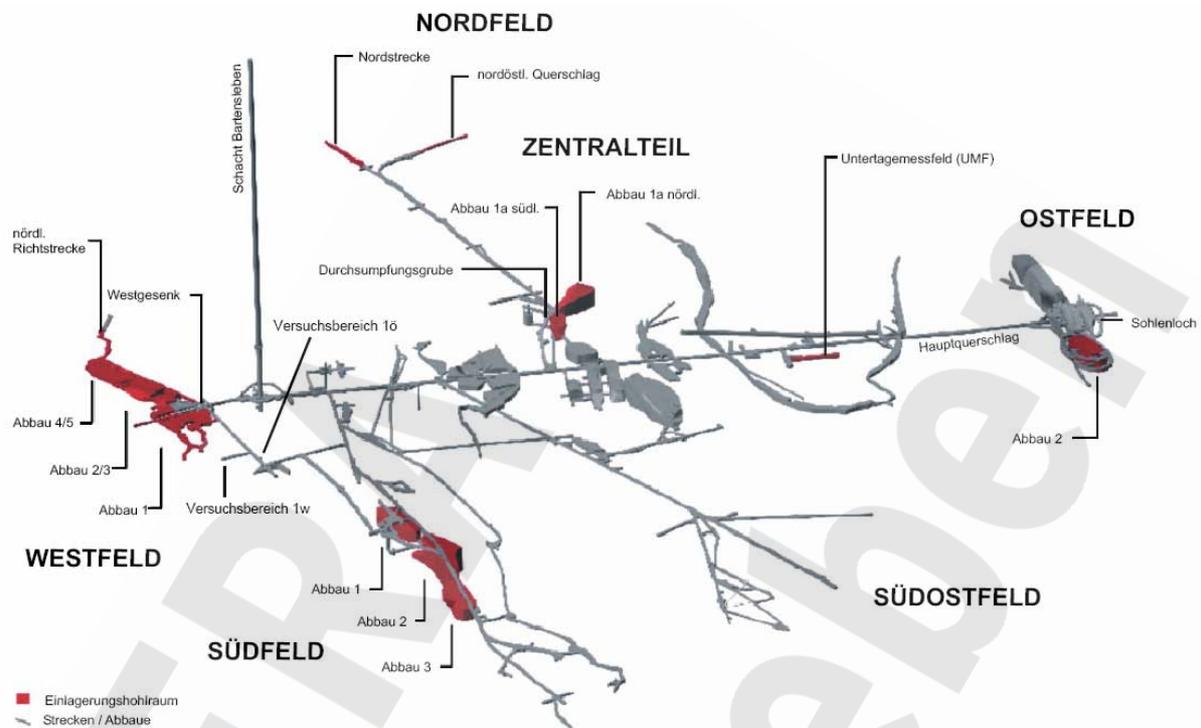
Einlagerungsgrubenbaue des ERAM
